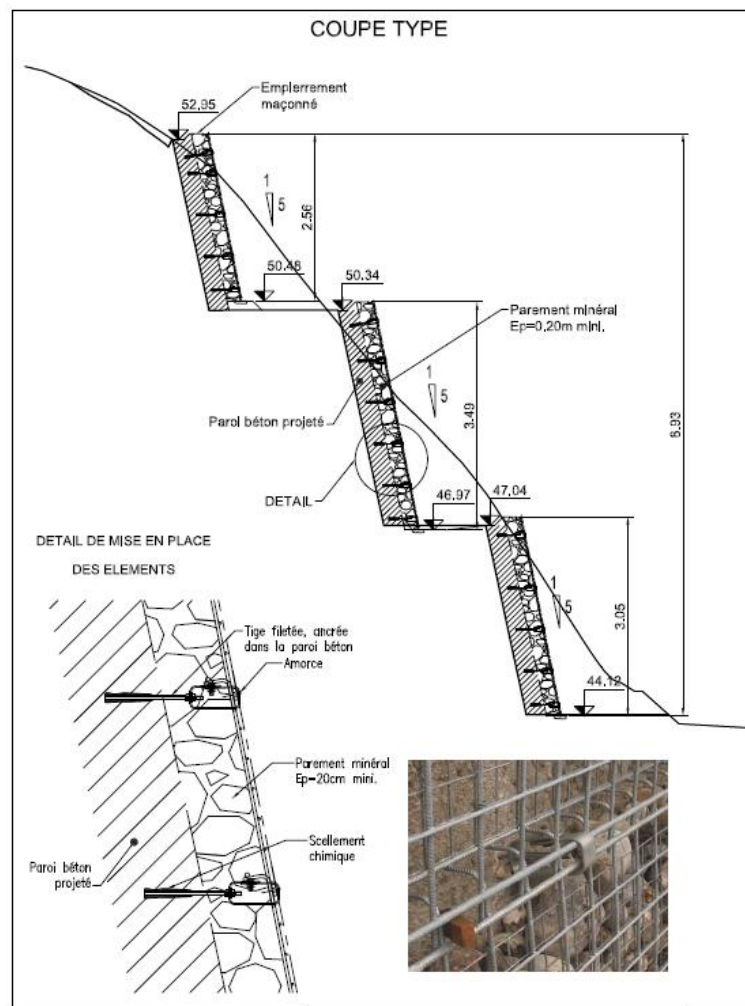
Coupe type d'une paroi clouée (source : Terre Armée)
